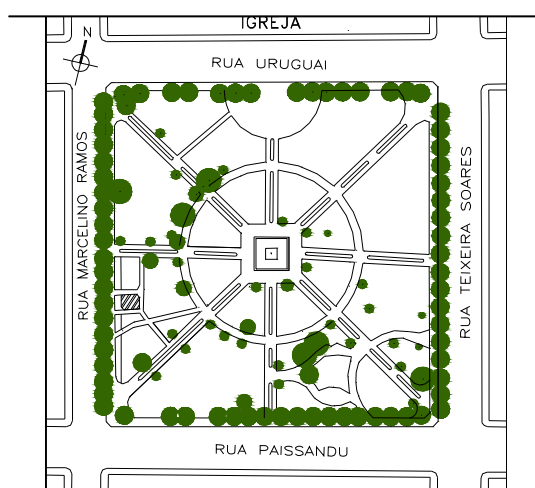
Planta Baixa da Praça Tamandaré com localização das árvores.
